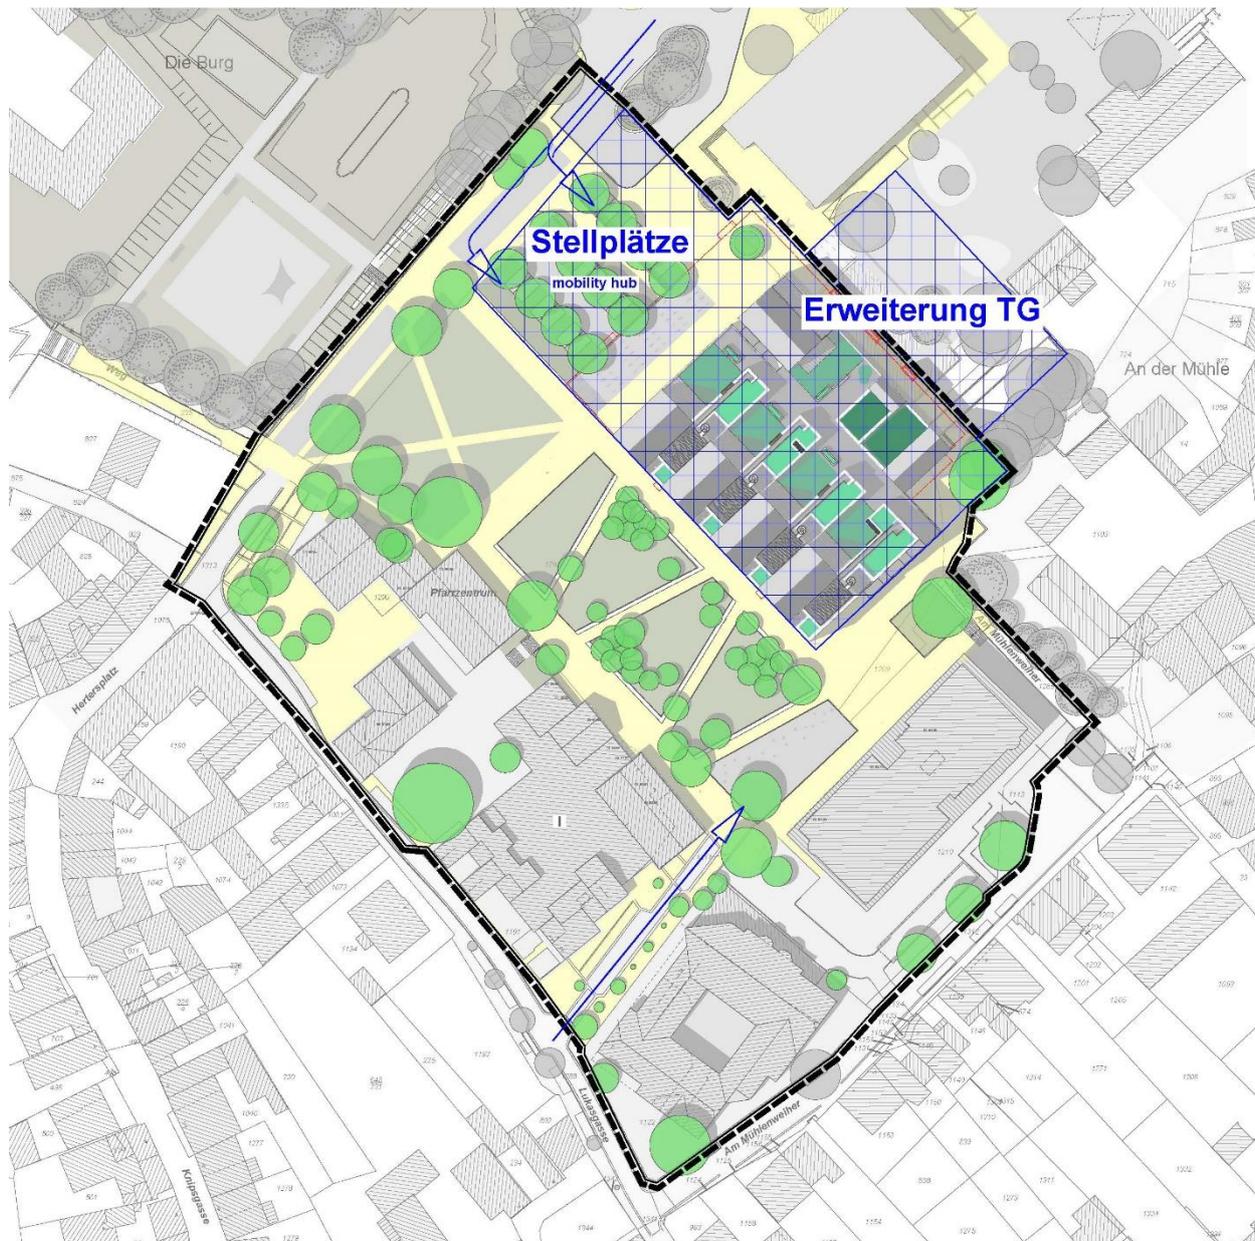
Fahrbeziehungen (Stadtplanung Zimmermann, ohne Maßstab)
